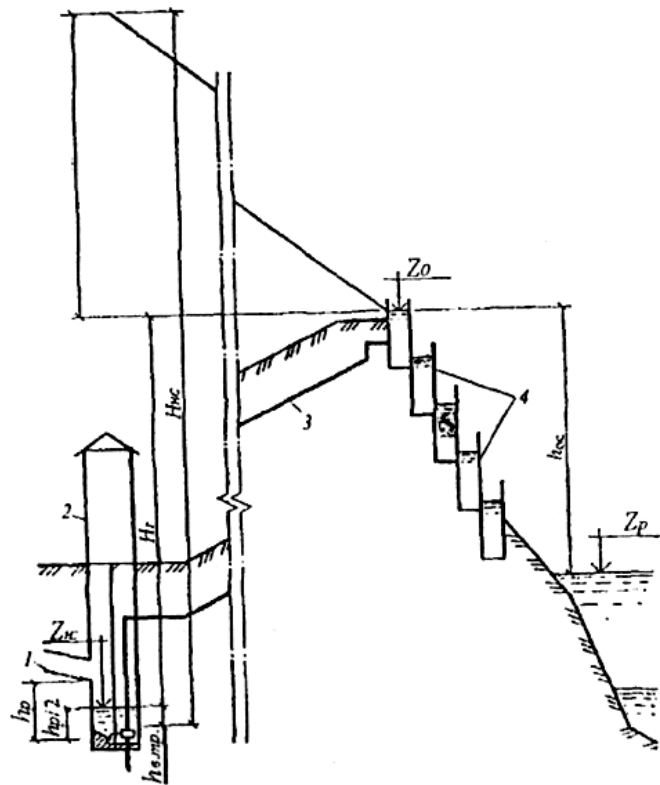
Высотная схема расположения насосной станции и напорного трубопровода: 1 – самотечный подводящий трубопровод; 2 – насосная станция; 3 – напорный трубопровод; 4 – очистные сооружения.
